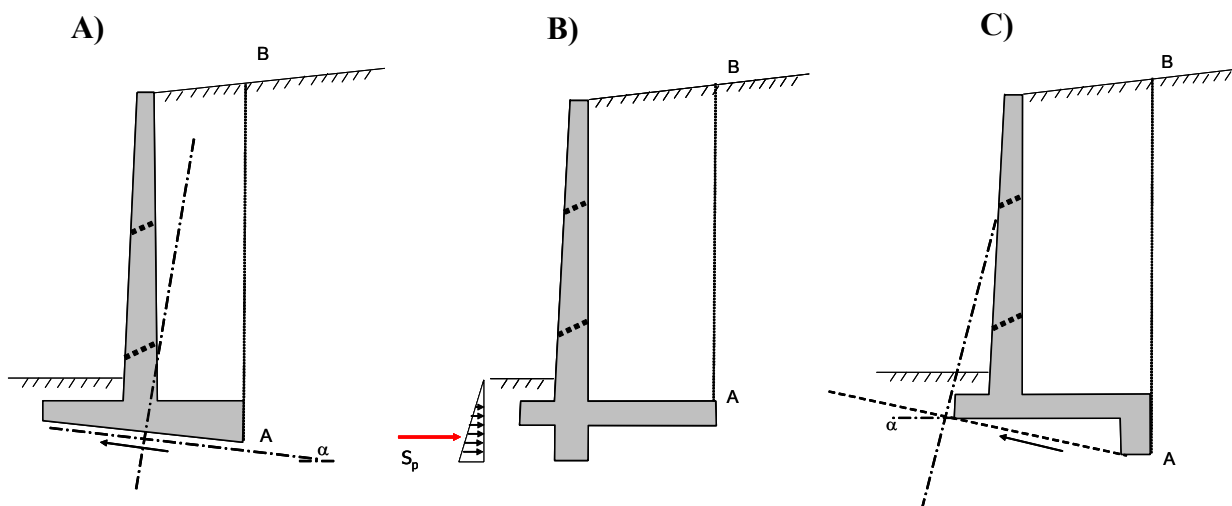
Incremento della resistenza allo scivolamento della struttura: A) Base di fondazione inclinata di un angolo α rispetto all'orizzontale; l'aumento della resistenza allo scivolamento è dovuto alla riduzione della componente tangenziale per effetto dell'inclinazione del piano di scorrimento. B) Muro con dente di fondazione in linea con il paramento verticale; l'aumento della resistenza allo scivolamento è dovuto all'incremento della spinta passiva sul lato di valle della struttura. C) Dente di fondazione realizzato nella parte posteriore della base di fondazione; la struttura si comporta come un muro con fondazione inclinata (A). Sono riportati per ogni soluzione i dreni del muro (in tratteggio) e la verticale AB su cui agisce la spinta attiva del terreno; si può notare come le soluzioni A) e B) comportino di contro un incremento della spinta attiva -
